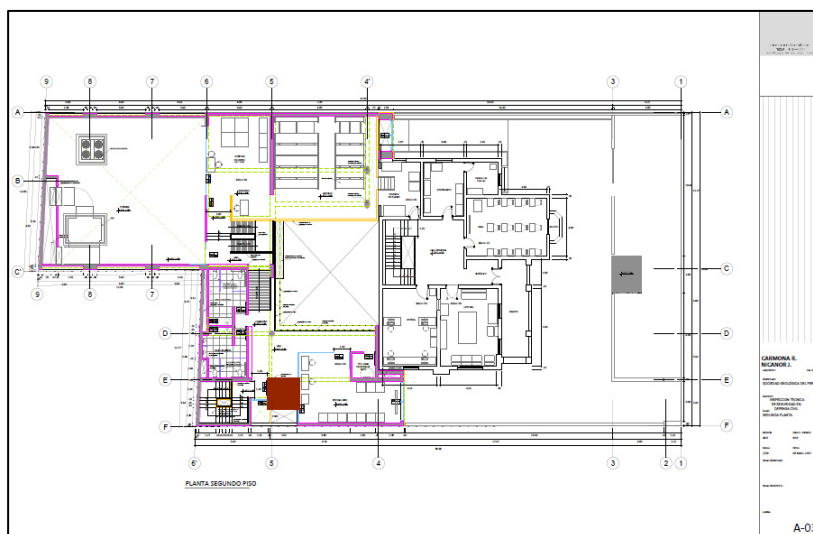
Imagen de plano de la 2º Planta de la SGP – resaltado con rojo el depósito. Fuente: SGP.
